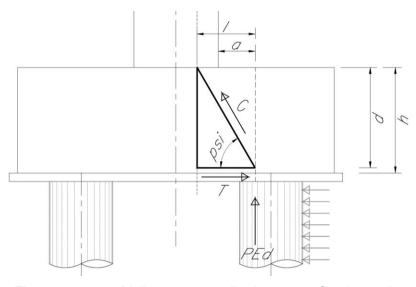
Tirante puntone - Biella compressa di calcestruzzo C e tirante di armatura T
